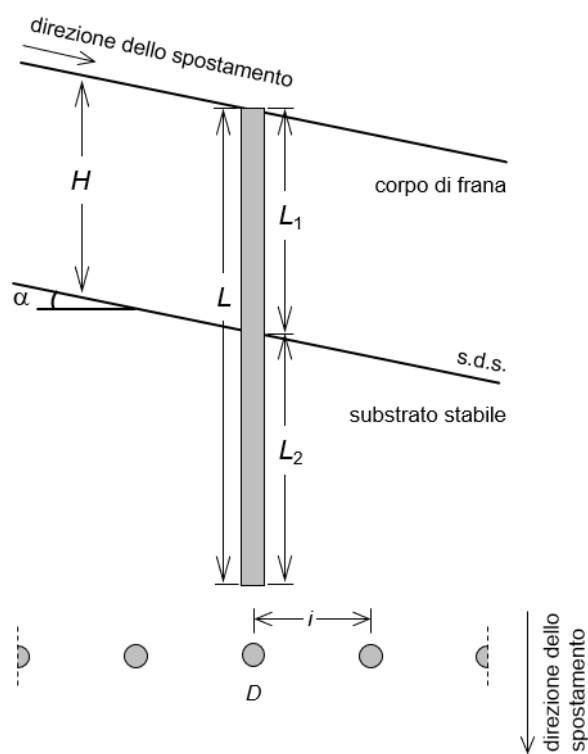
Sezione longitudinale (in alto) e vista in pianta (in basso) dello schema geometrico di riferimento e principali grandezze osservate.
